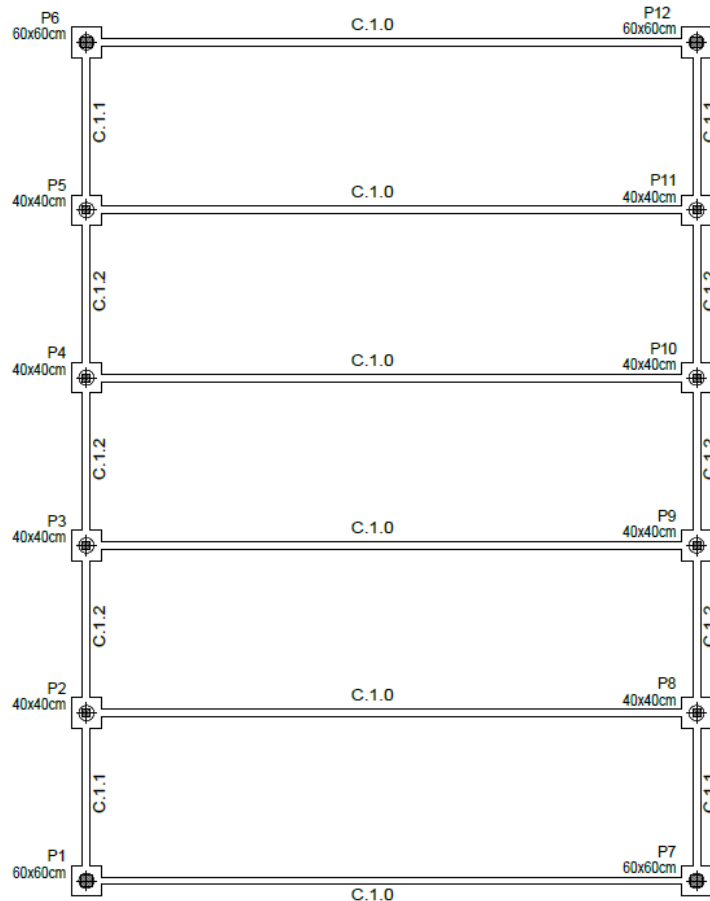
Distribución en planta de los encepados y pilotes. Fuente: Elaboración propia
